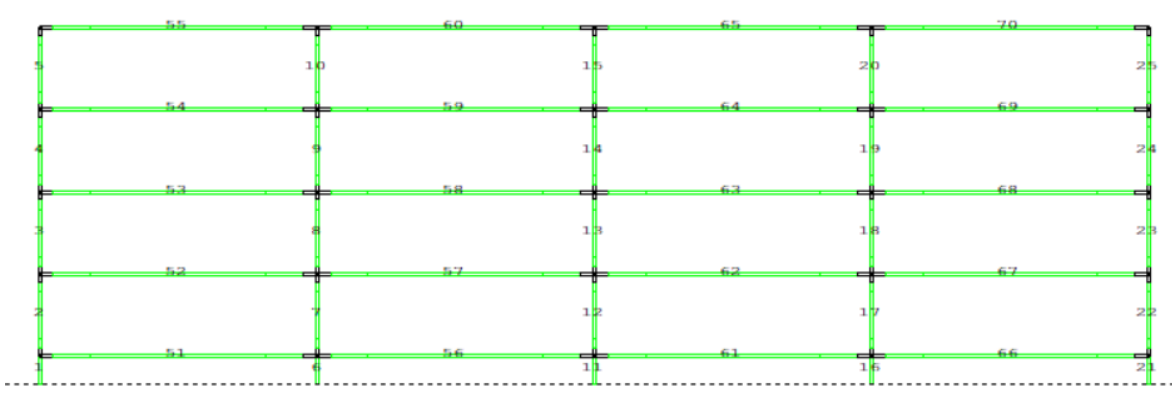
Modelo plano en Ruaumoko 2D del eje perimetral
